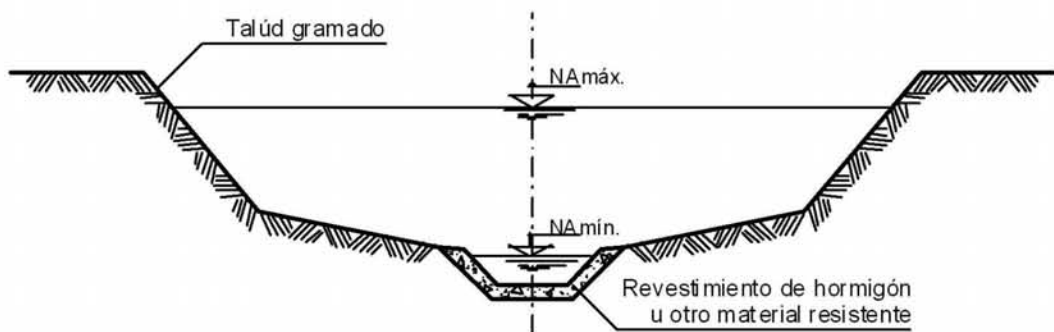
Canal en hormigón - Sección rectangular mixta
